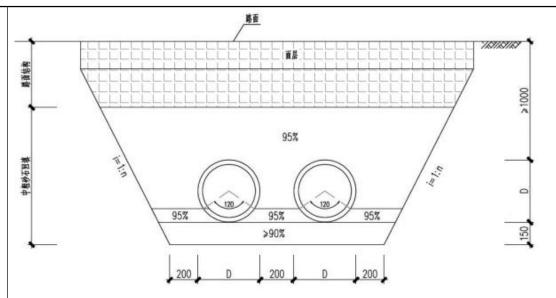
双管同槽破路沟槽开挖回填断面图
